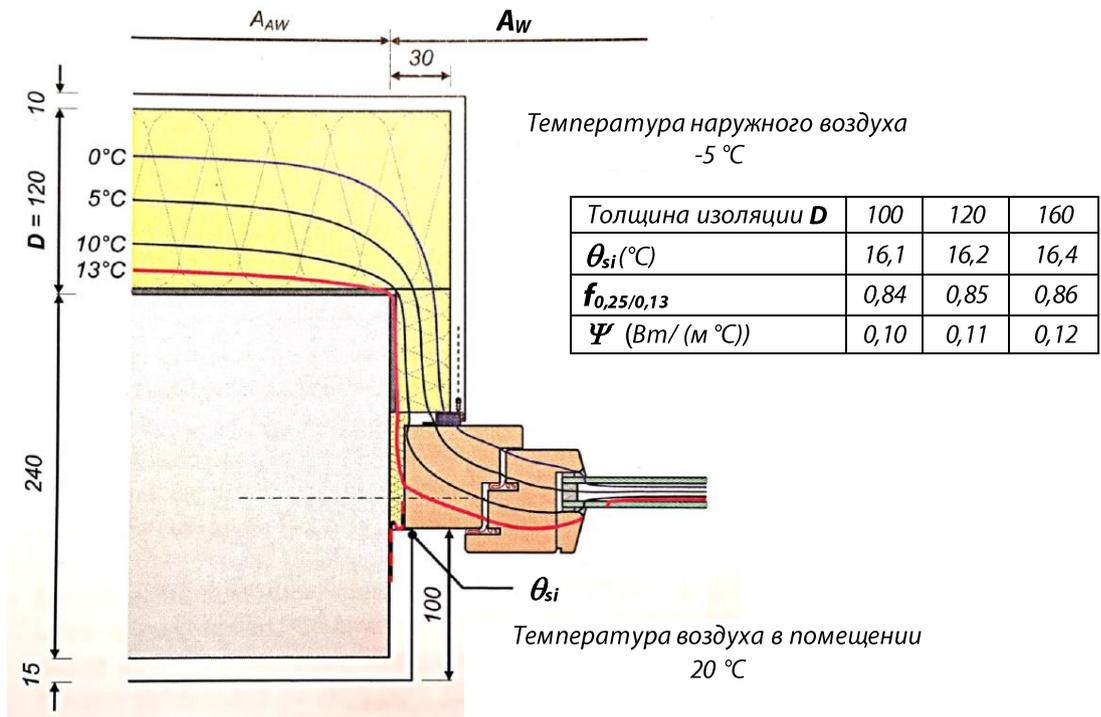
Бетонная стена с теплоизолирующей композитной системой, деревянное окно (сосна) с теплоизоляцией откосов.
